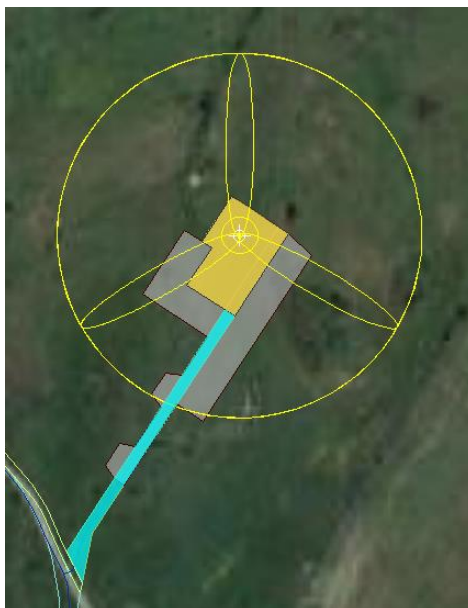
schema piazzole (ciano=accesso; grigi=aree temporanee di cantiere; giallo=area fase di esercizio)
